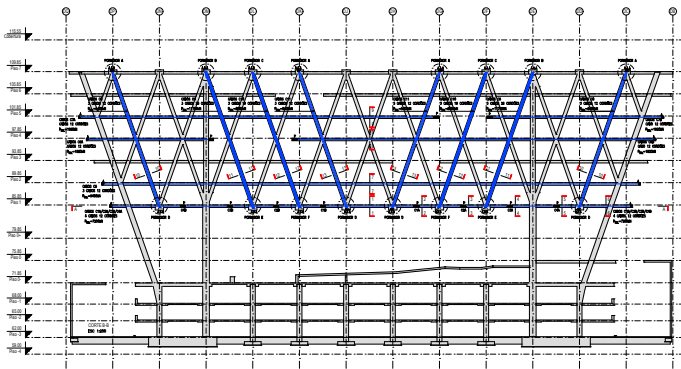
Pré-esforço da treliça da fachada (vão 60 m). Prestress in the façade truss (60 m span).
